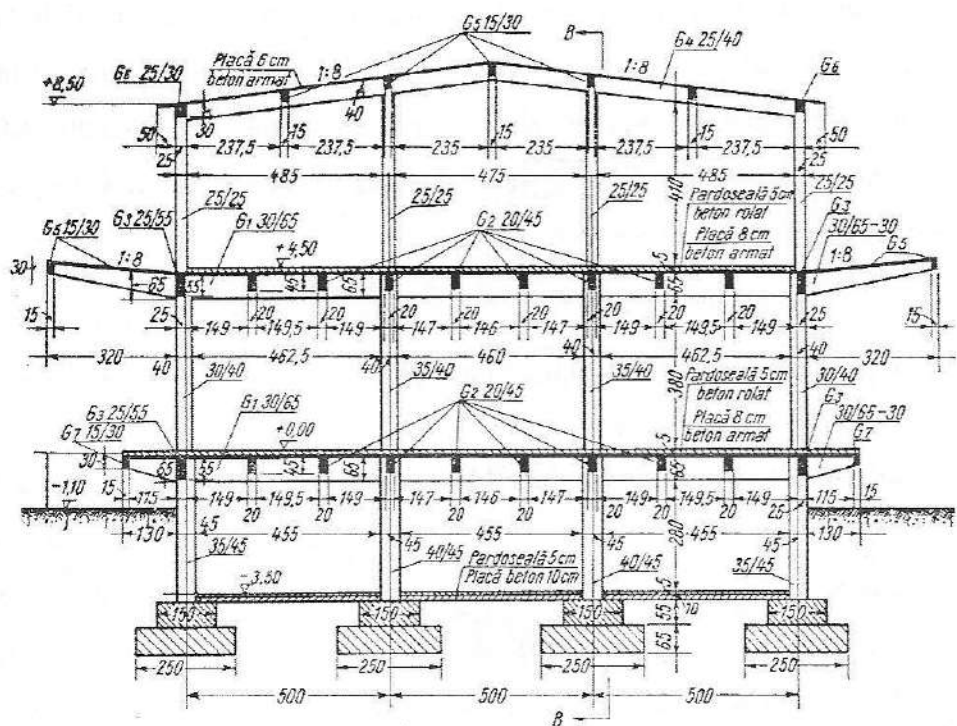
Magazie cu etaje realizată din beton armat monolit.
